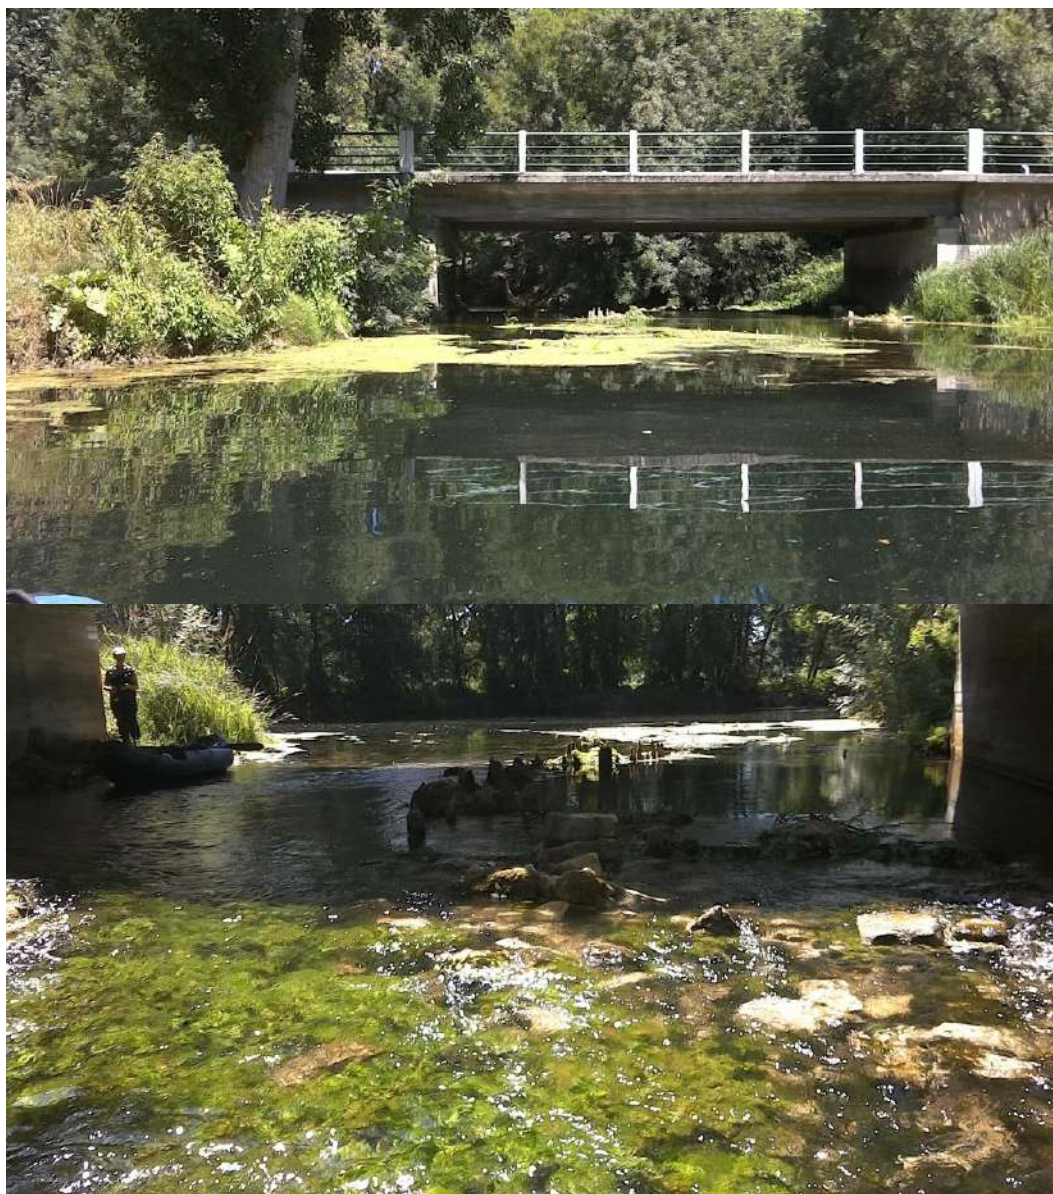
Pont de la RD 136 sur le fossé du Traud à Colombiers
